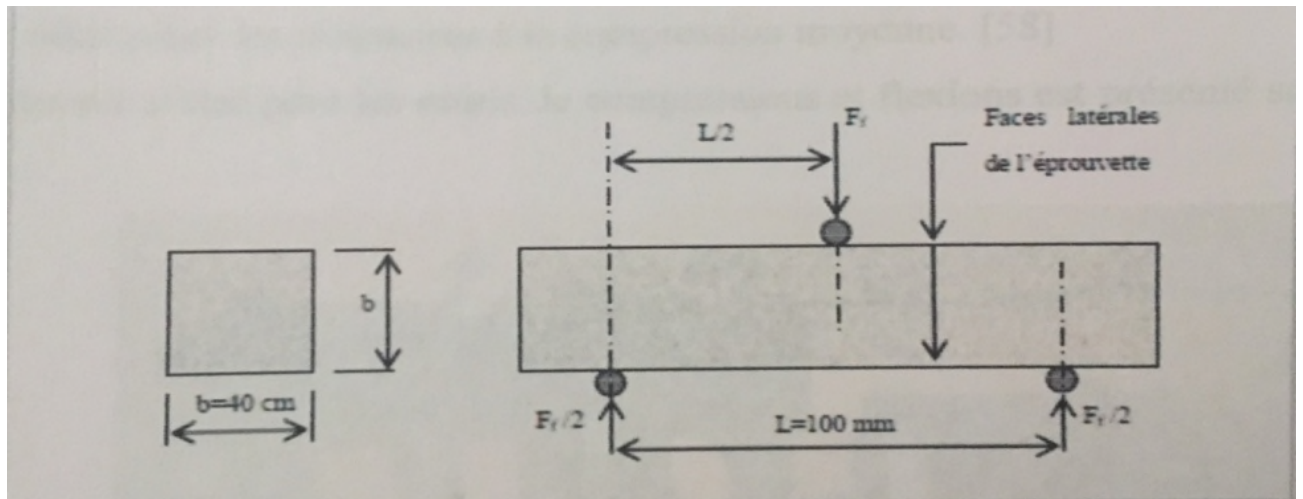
Mesure de la résistance à la flexion pour des éprouvettes.
